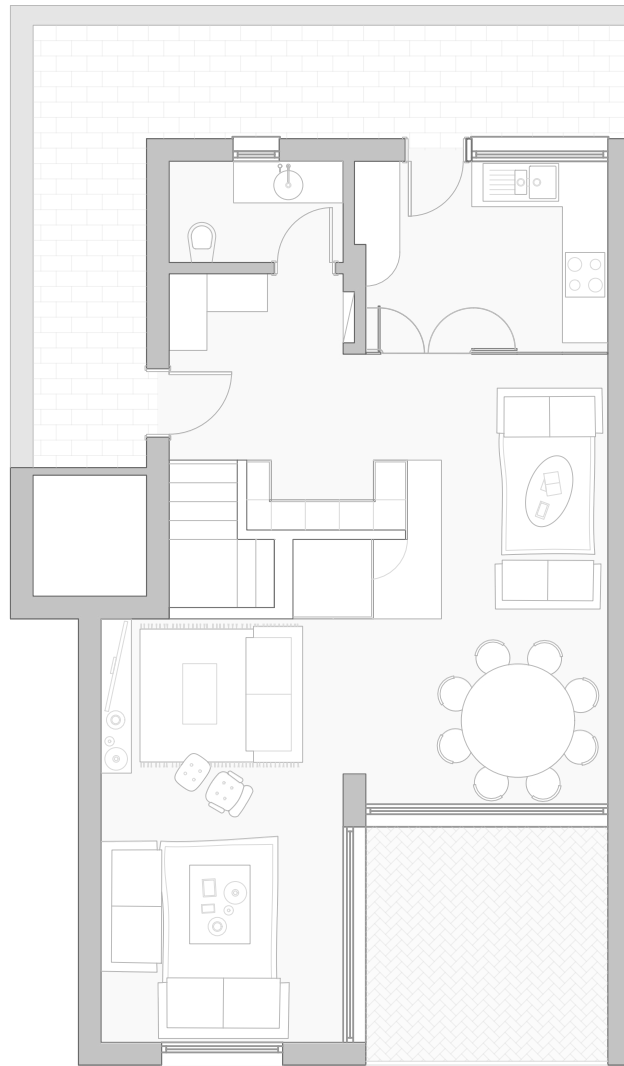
Planta T4 2x1 Piso Inferior 1:100
